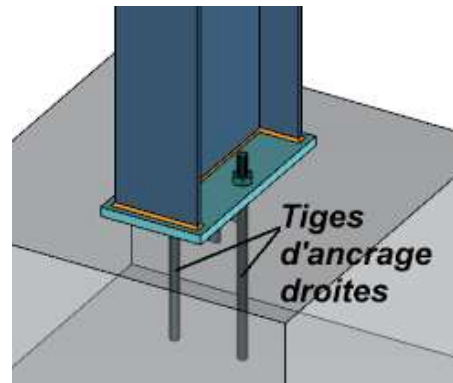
Assemblage poteau métallique et demi poteau en béton
